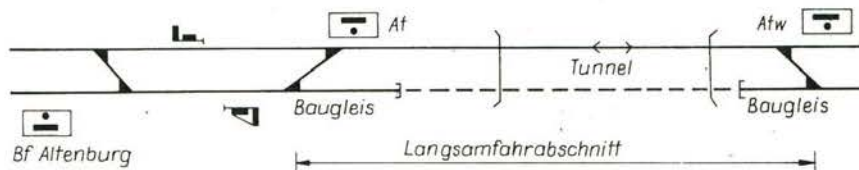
Tunneleinfahrt noch mit zweigleisiger Strecke (1958)
